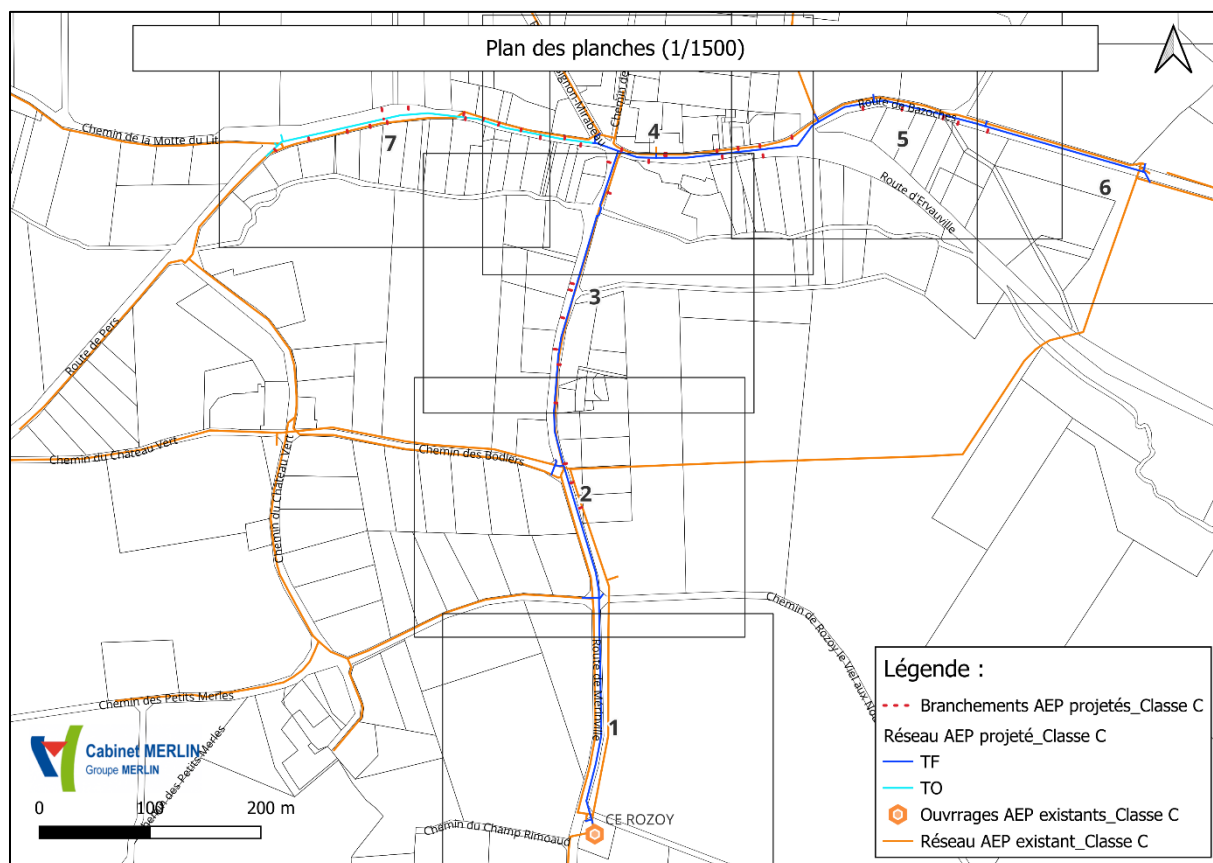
Plan du réseau projeté par rapport au bourg de Rozoy-en-Vieil
